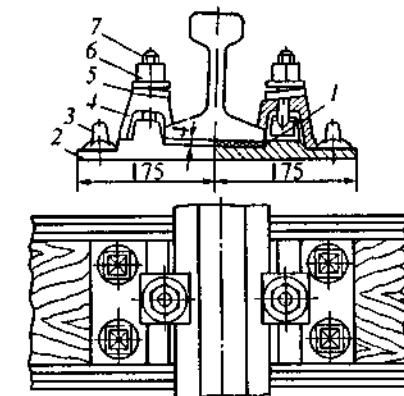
Промежуточное раздельное скрепление для деревянных шпал: 1 — прокладка; 2 — подкладка; 3 — шуруп; 4 — клемма; 5 — двухвигтовая шайба; 6 — гайка; 7 — клеммный болт
